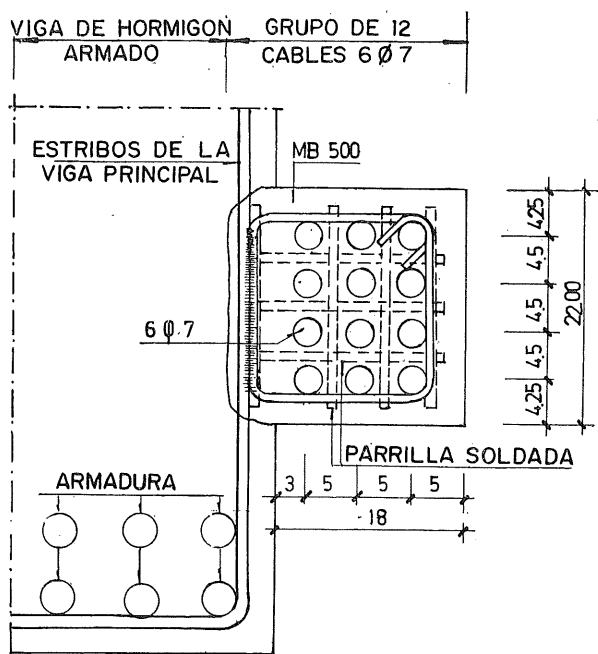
Sección transversal de un grupo de 12 cables 6 \varnothing 7, y su unión a la viga de hormigón armado.
